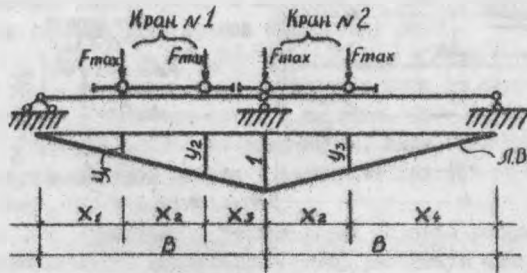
Схема загрузки разрезных подкрановых балок при определении давления на колонну
